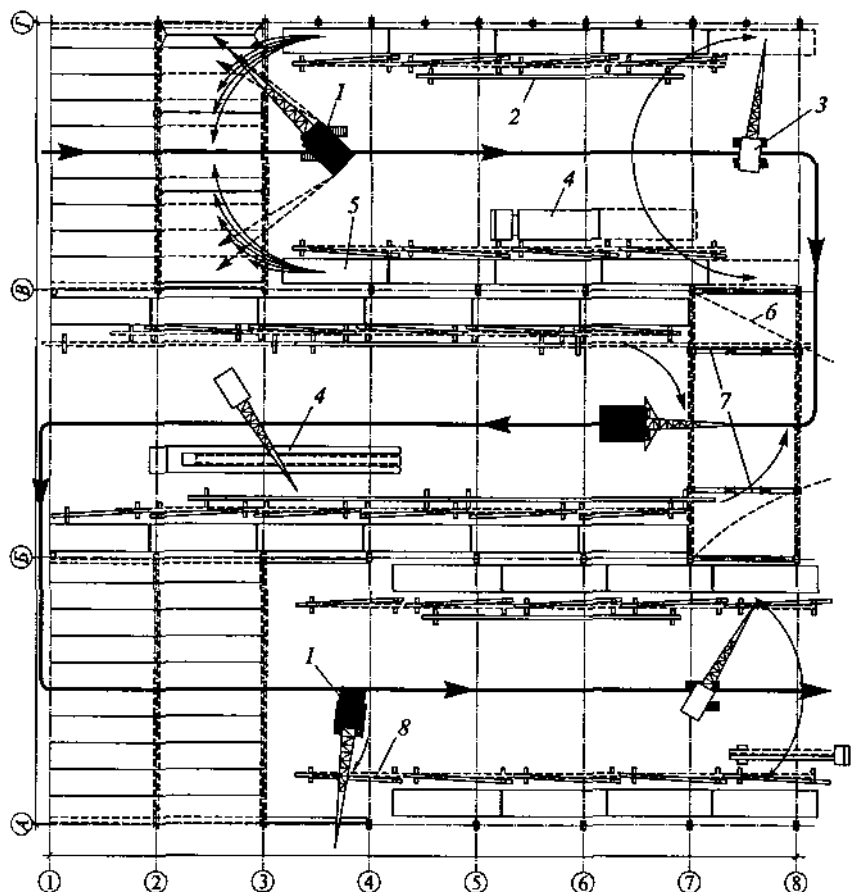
План монтажного участка трехпролетного одноэтажного здания:
